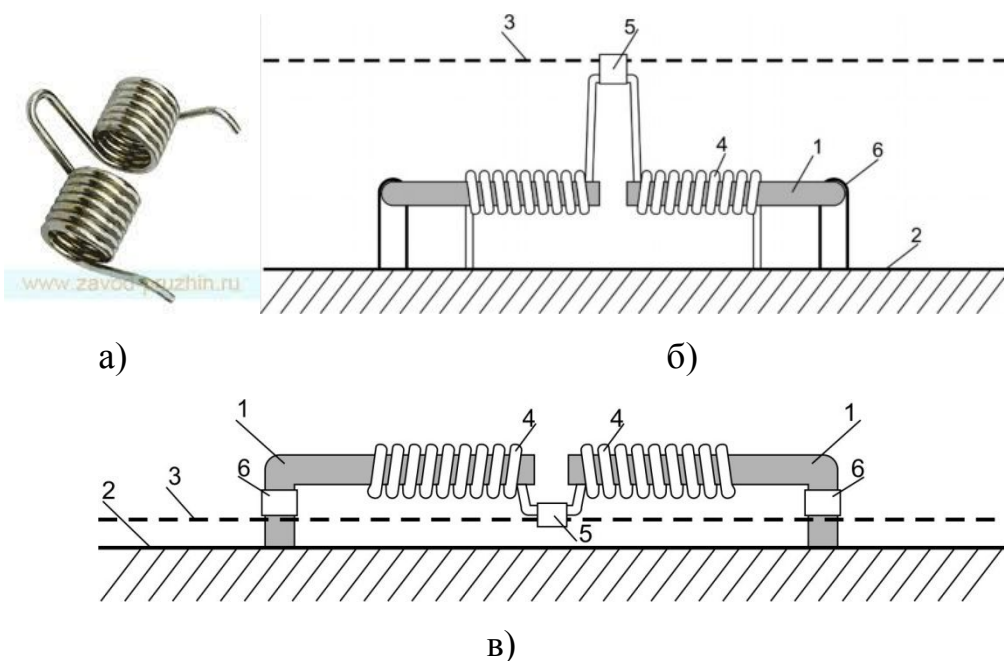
Комбинированный гаситель колебаний торсионного типа: а – пружина кручения, б – комбинированный гаситель (вид спереди); в – комбинированный гаситель (вид сверху). 1 – ДГКТТ; 2 – конструкция каркаса; 3 – легкое сетчатое ограждение; 4 – пружина кручения; 5 – элемент с помощью которого гаситель крепится к ограждению; 6 – крепежный элемент (хомут).
